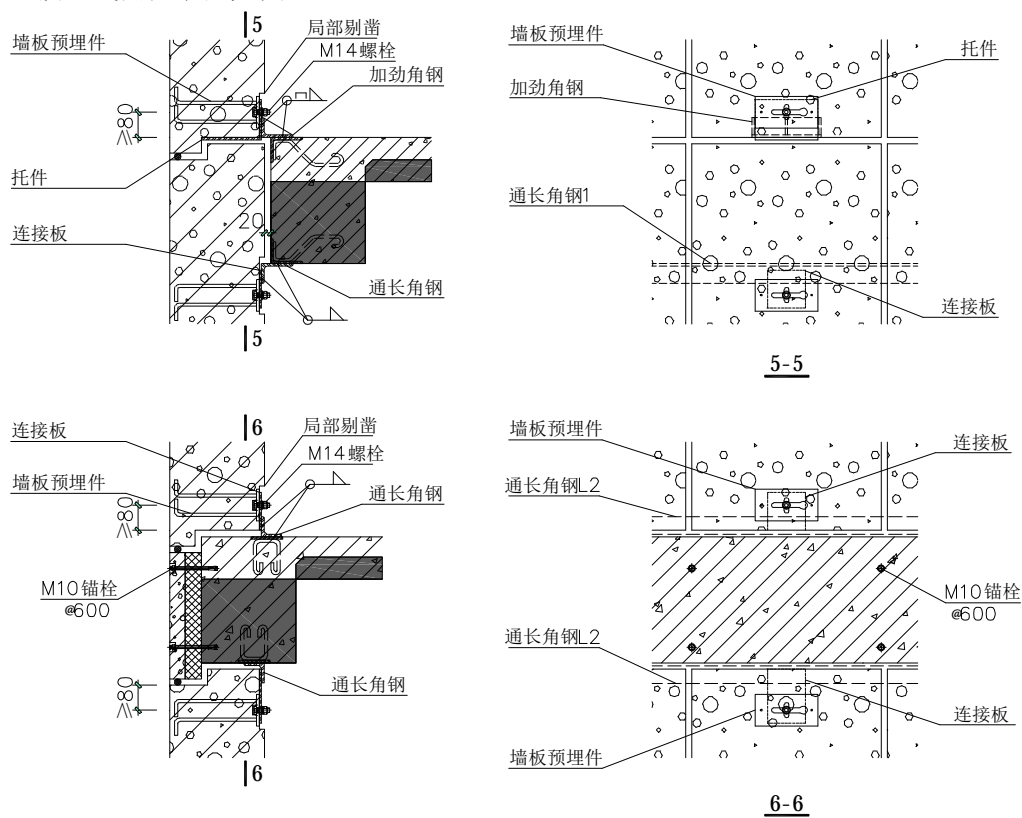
钢筋混凝土结构 AAC 板外墙预埋件节点
